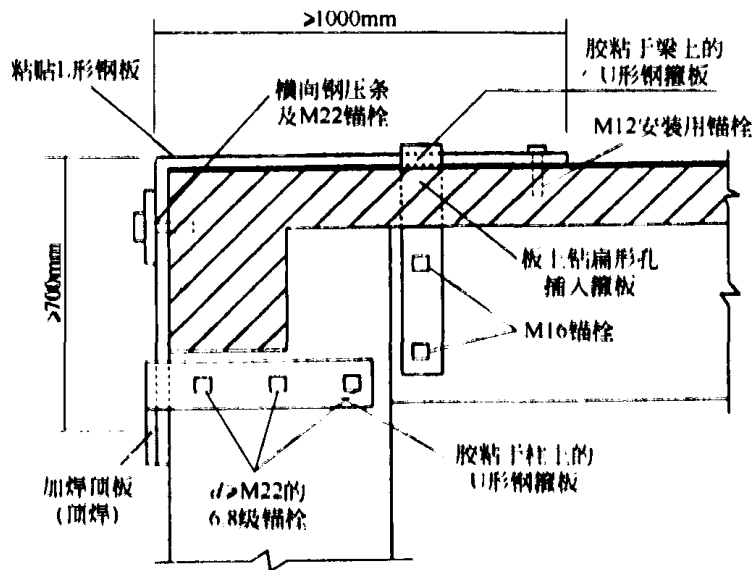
柱顶加贴 L 形钢板及 U 形钢箍板的锚固构造示例
